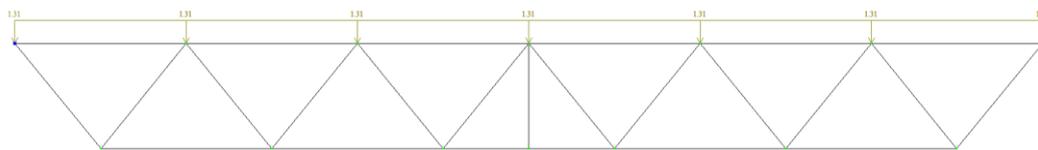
Приложение нагрузки на верхний пояс фермы от пирога кровли
